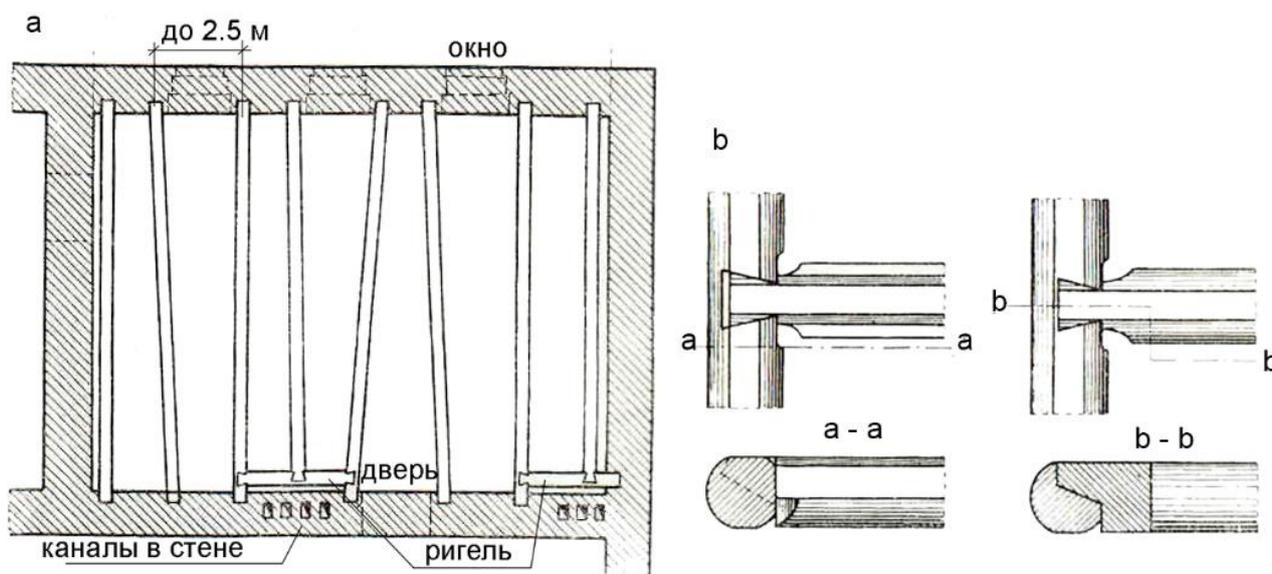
Перекрытие по деревянным балкам: а – схема раскладки деревянных балок; б – варианты сочленения врубкой основной балки и ригеля [33]
